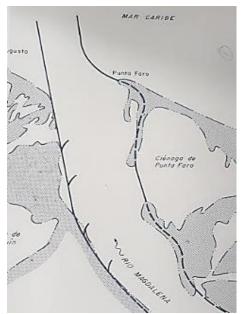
Proyecto Black Mackeney & Stewart, 1923 (adoptado para construcción)
